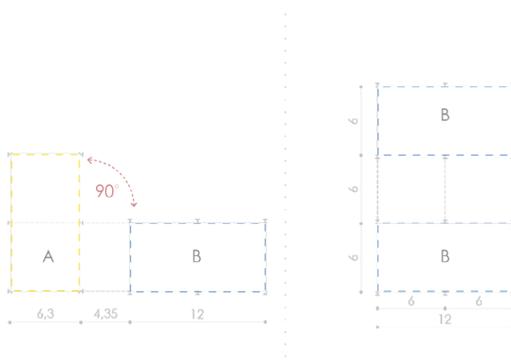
Esquema en planta S/E estrategia de geometrización
